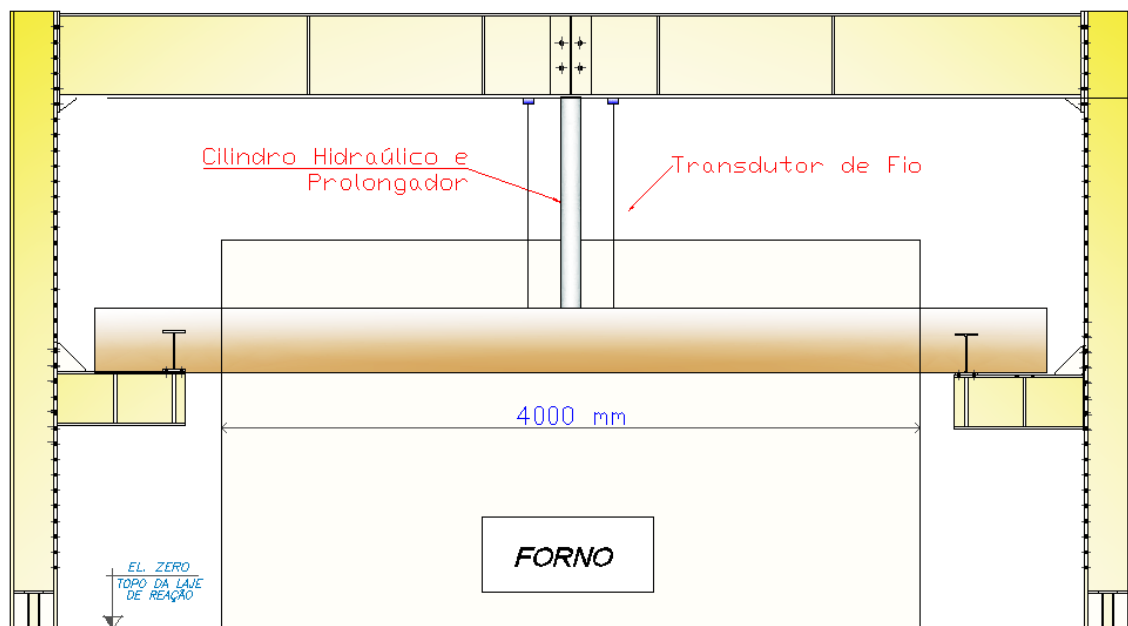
Layout da montagem do ensaio com aplicação de carga (flexão à três pontos).
